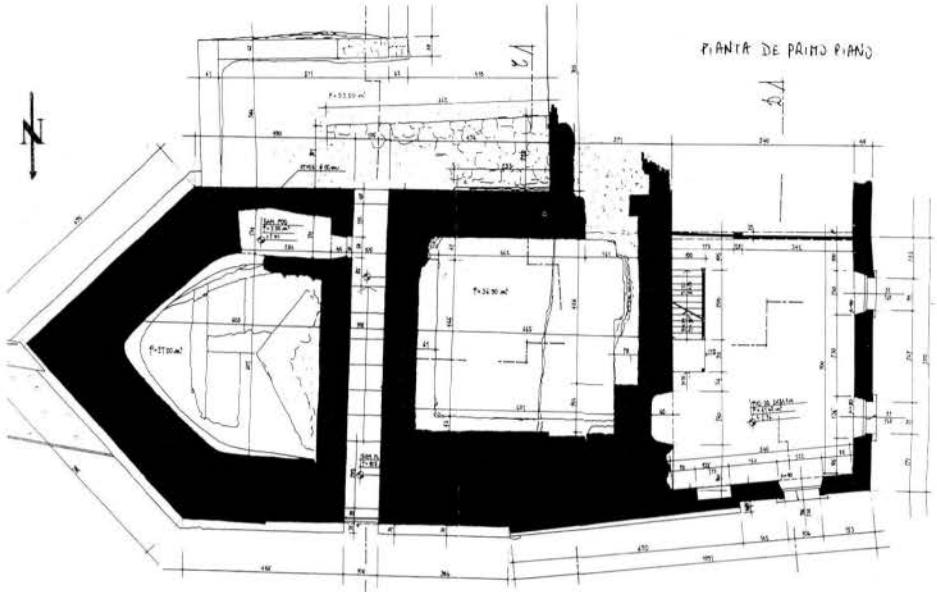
Pianta dell'architettura oggetto di ricerche (T. Pavlović - A. Marion).
